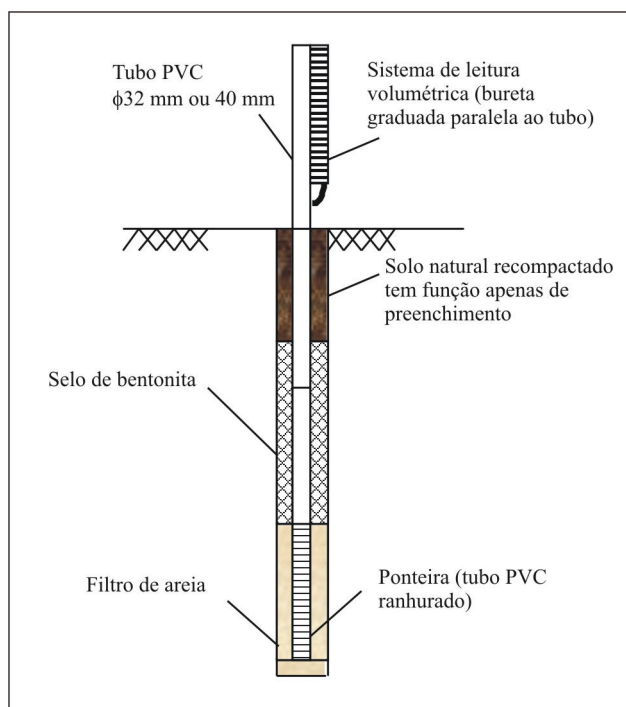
Ensaio de  $k$  com piezômetro escavado.
